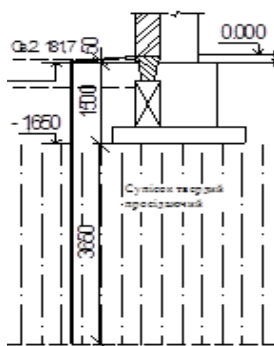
Вертикальна прирізка фундаменту на перетині осей А і 3.
